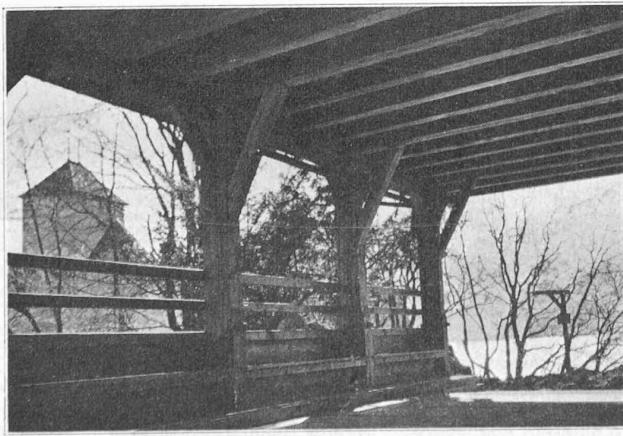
Le nouveau couvert en bois du château de Chillon, vue de dessous.
